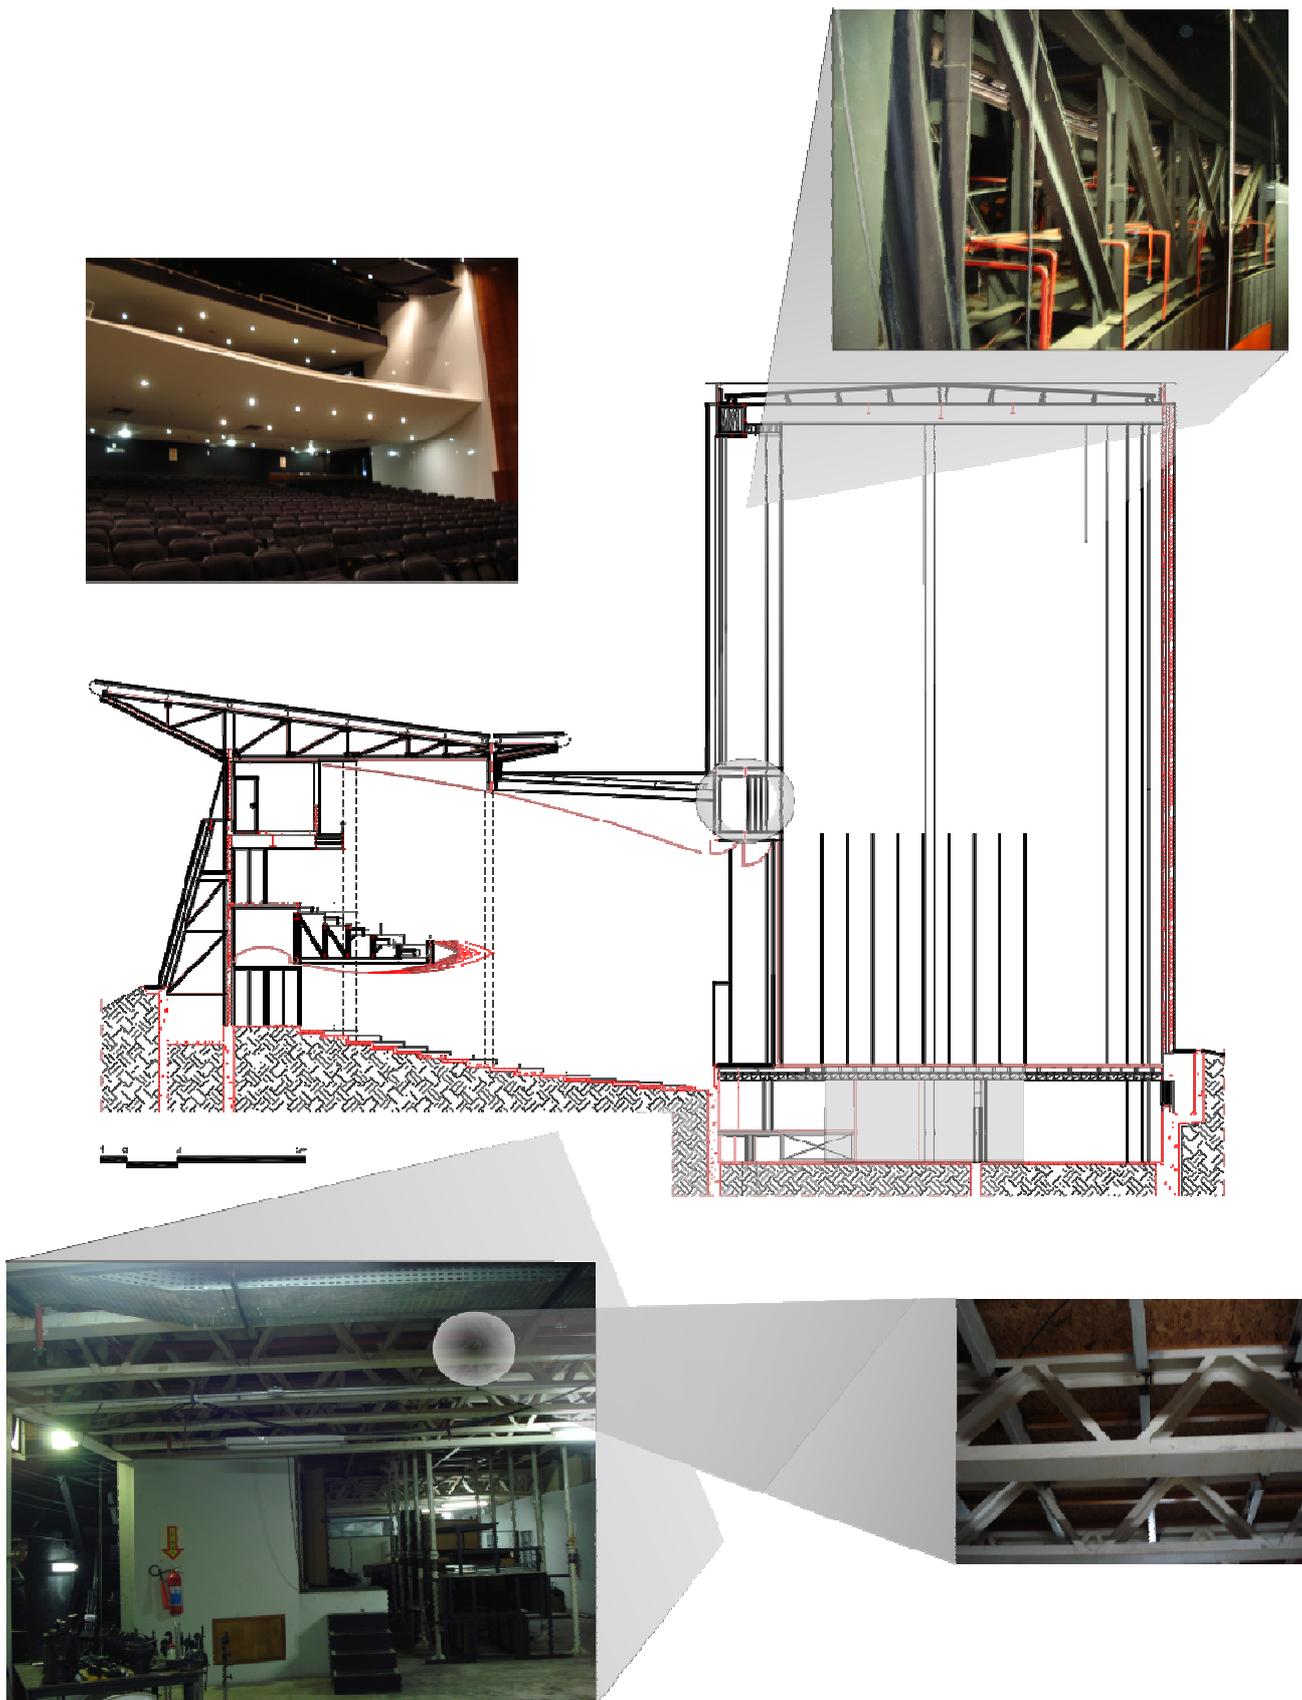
Corte e imagens da Administração e Galeria – Conjunto Estrutural.
